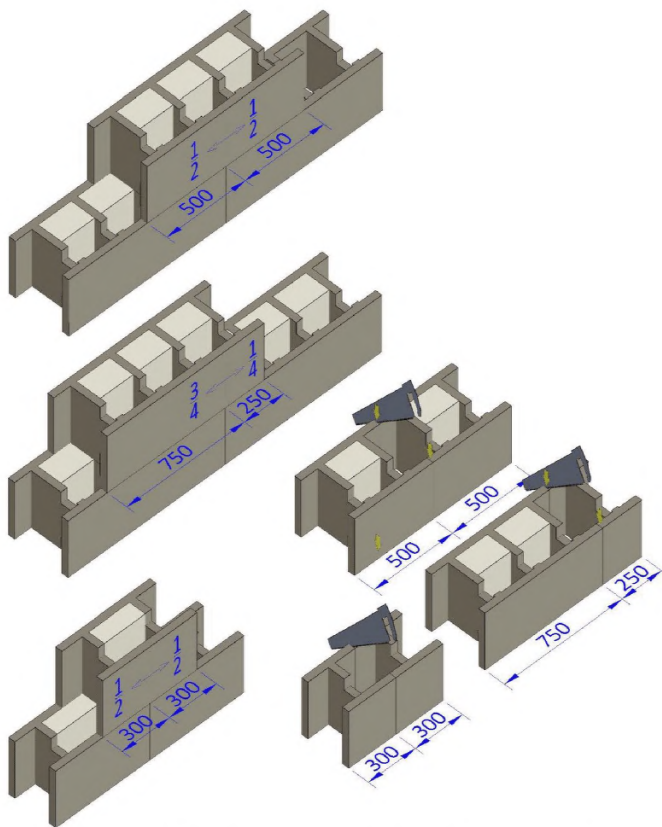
Схемы перевязки рядовых блоков 38/15 «Р» и 30/15 «Р» при кладке стен
